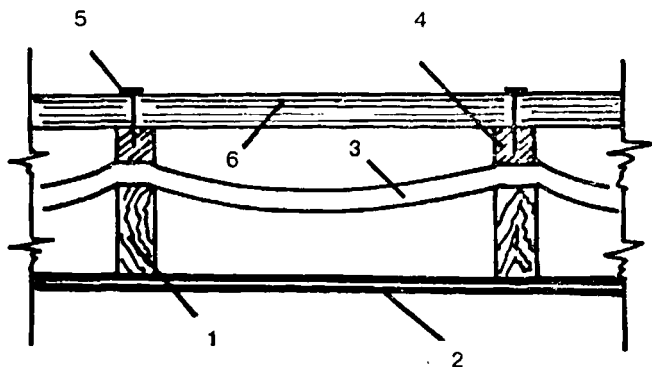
Звукоизоляция пола в деревянных перекрытиях:
